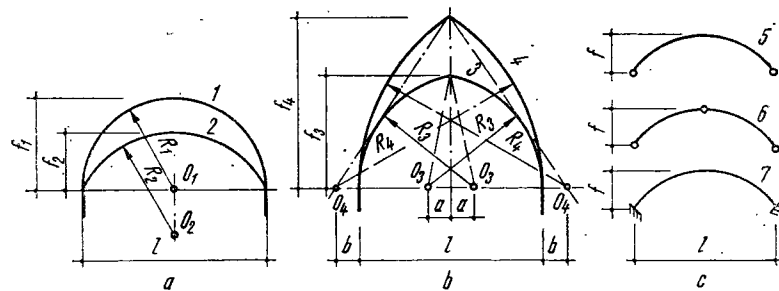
Forme geometrice ale bolților din zidărie pentru planșee :
